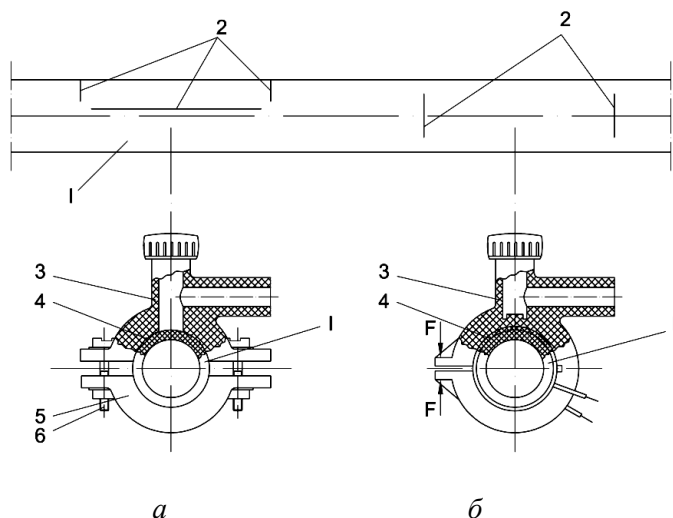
Соединение полиэтиленовой трубы и седловых отводов с закладными нагревателями:
